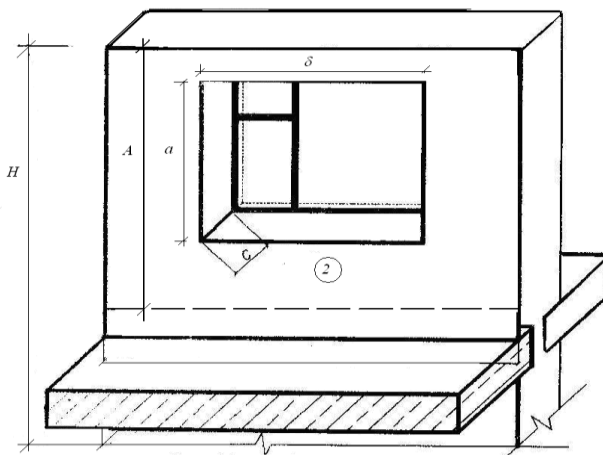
Схема фрагмента 2 расчётного участка наружной стены
